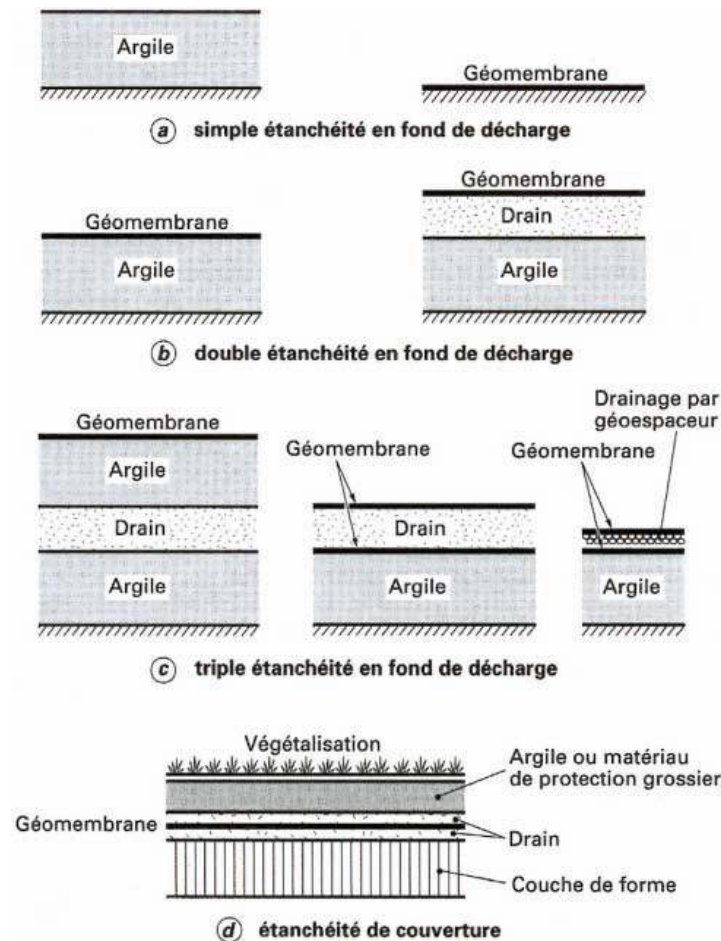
Différentes combinaisons et structures d'étanchéité en fond et couverture de décharge
